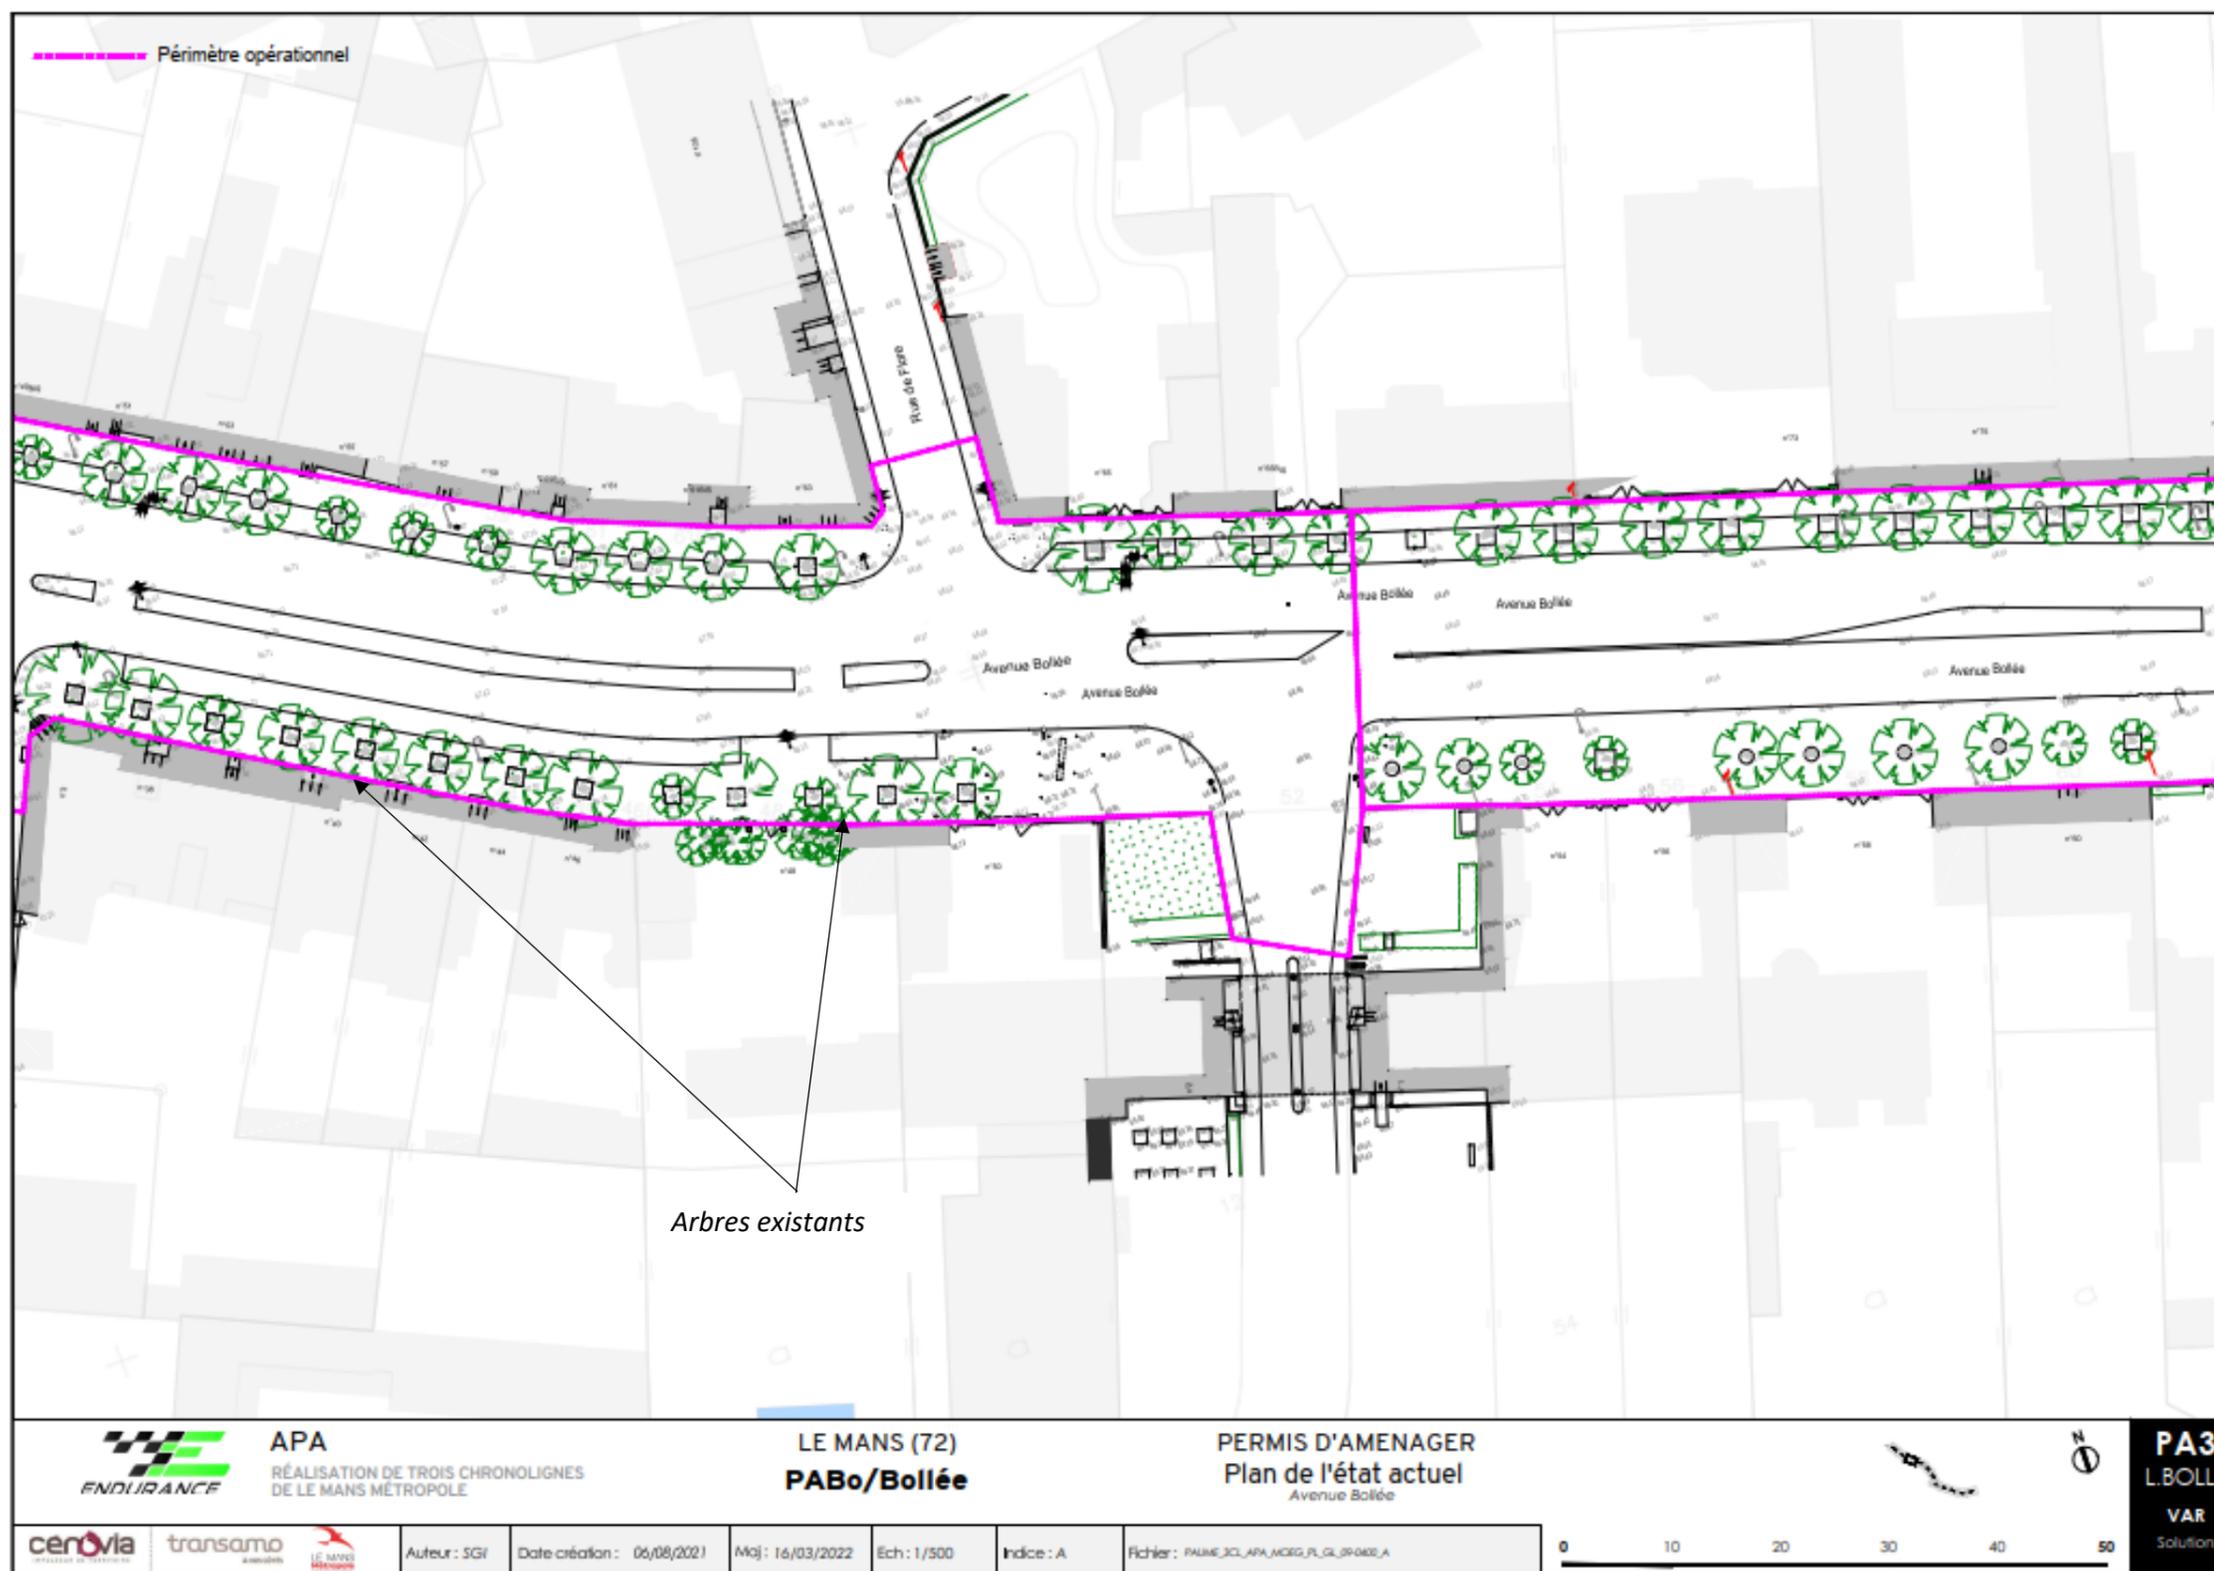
plan topographique actuel avec mise en couleur des arbres existants et du périmètre d'intervention « façade à façade » sur l'Avenue Bollée
